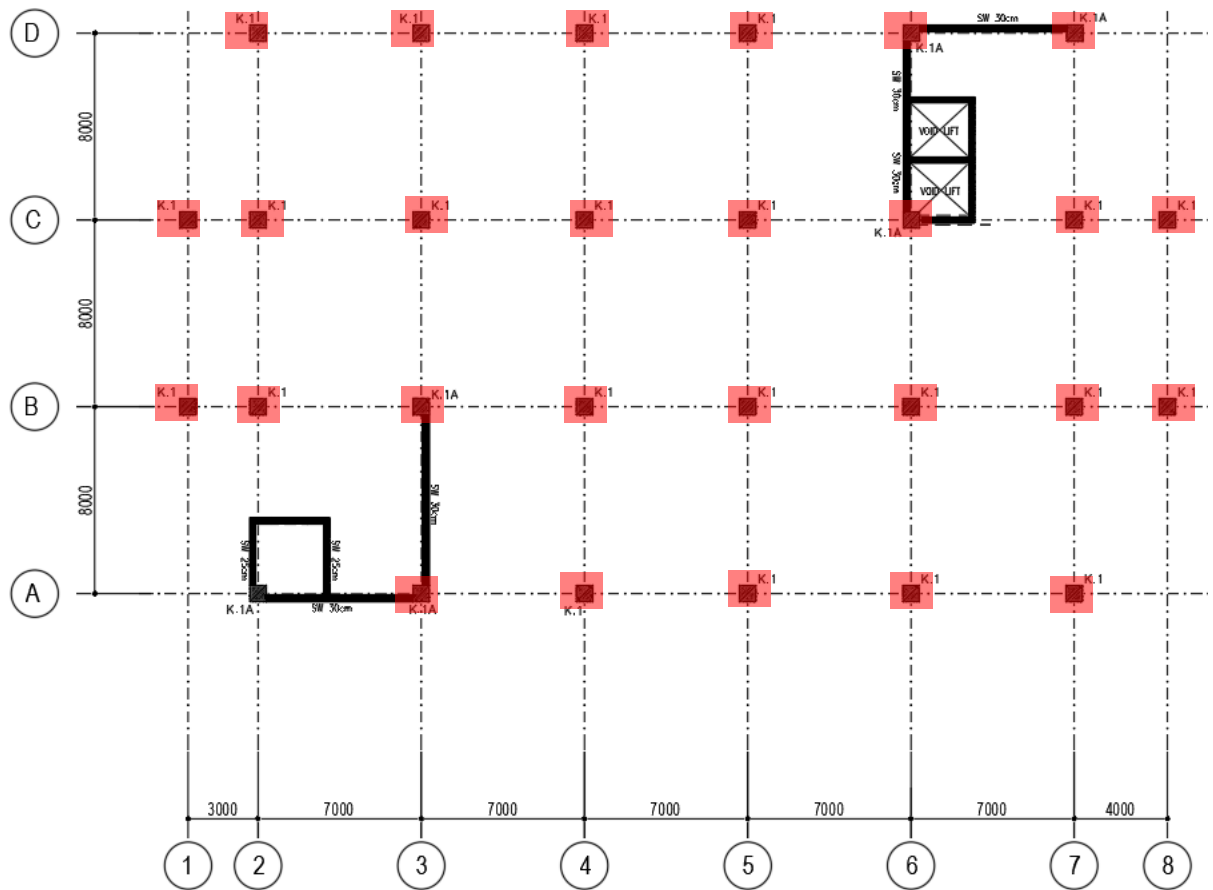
Pekerjaan Pengecoran Shear Wall
